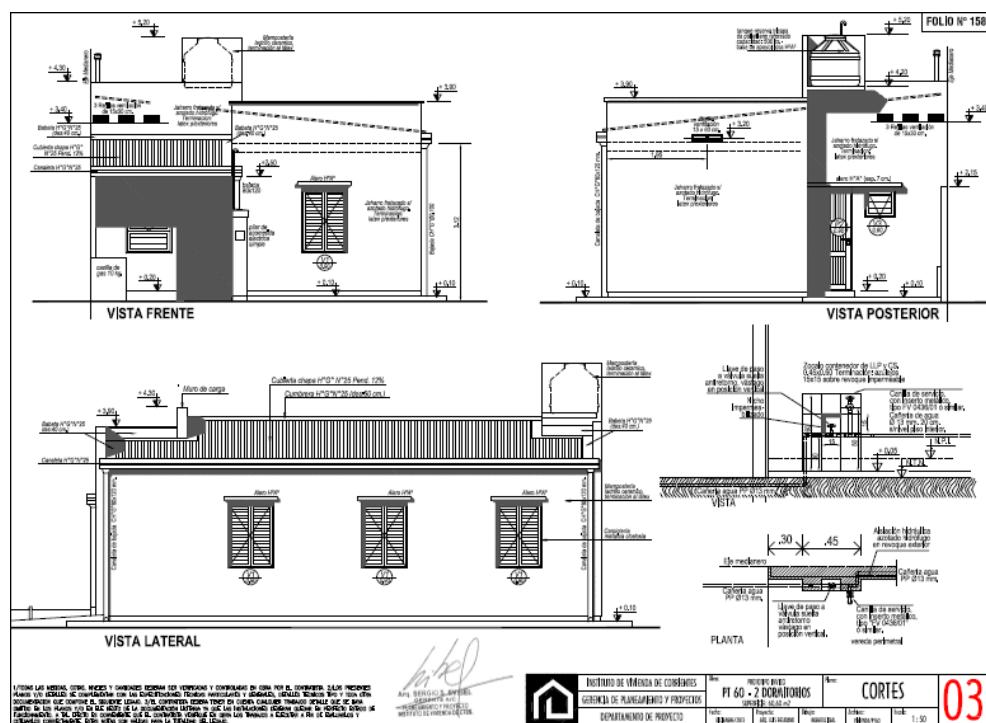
Vistas del Prototipo Universal, construido en el barrio Concepción.
